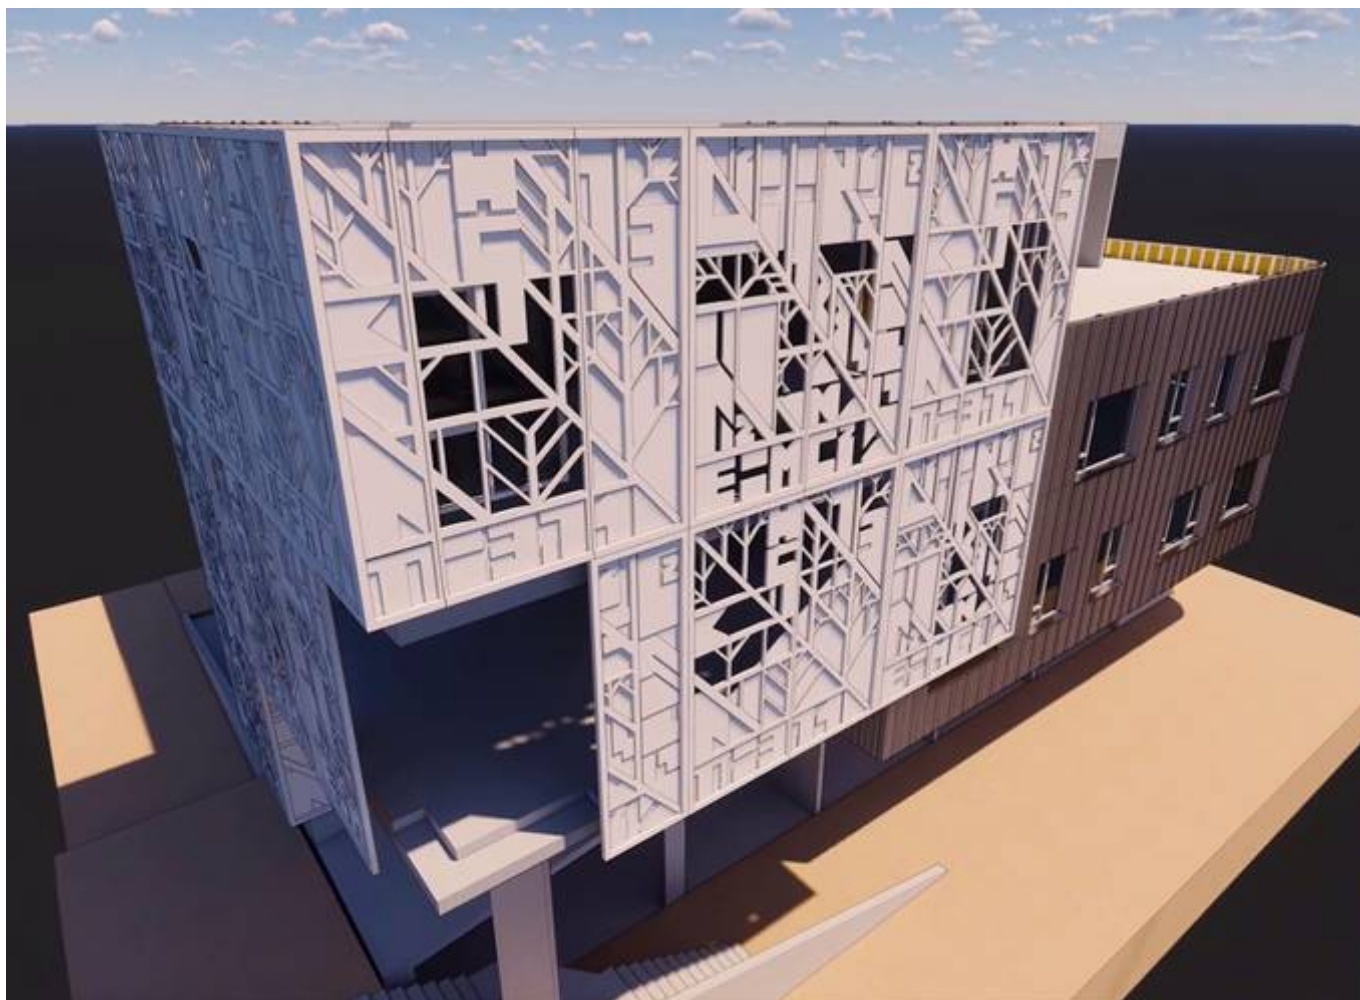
Пример выполнения модульного навесного фасада из крупноформатных бетонных перфорированных панелей, выполненных из архитектурного бетона
